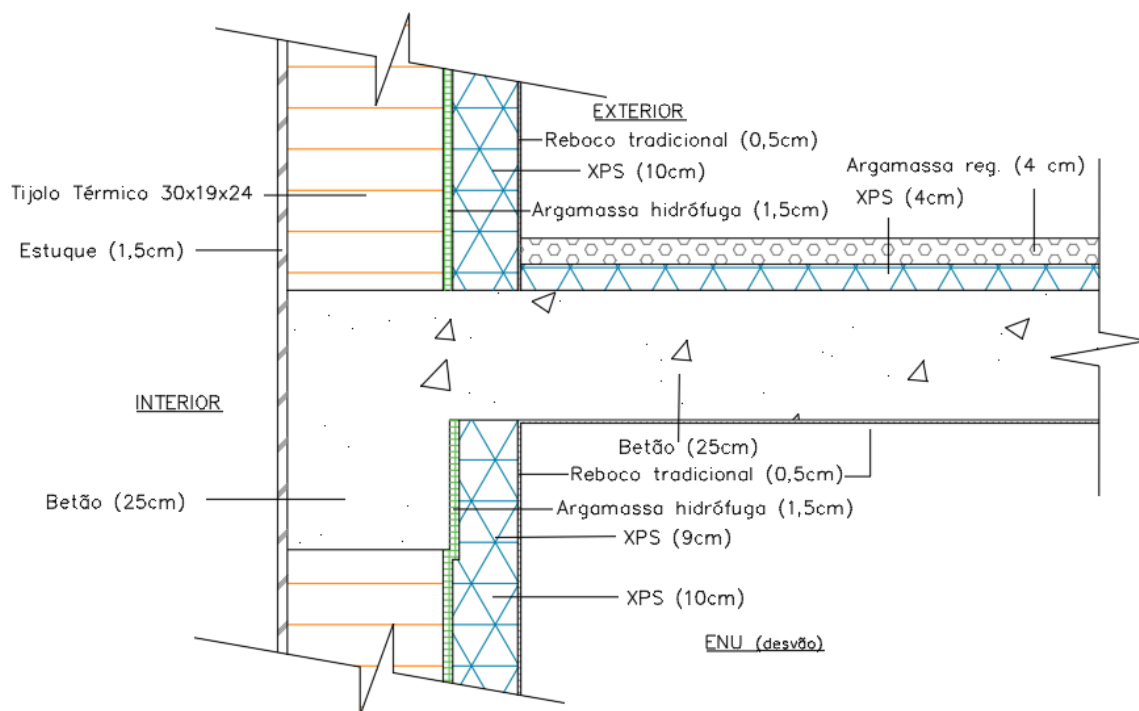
Exemplo de pormenor construtivo da PPI2 da proposta de alteração
